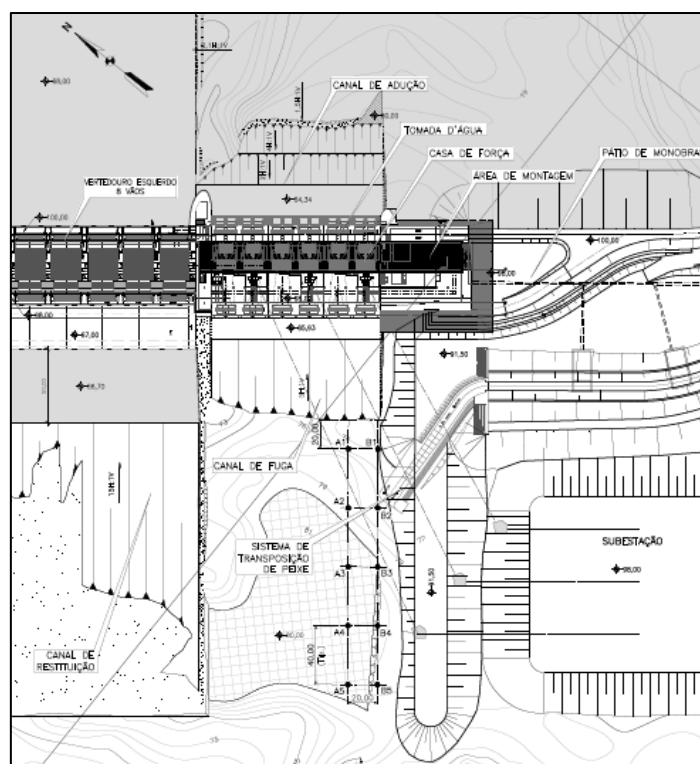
6 – Arranjo em planta da Alternativa Inicial para dique junto à entrada do STP (Anexo 1, LEME (2012)).
